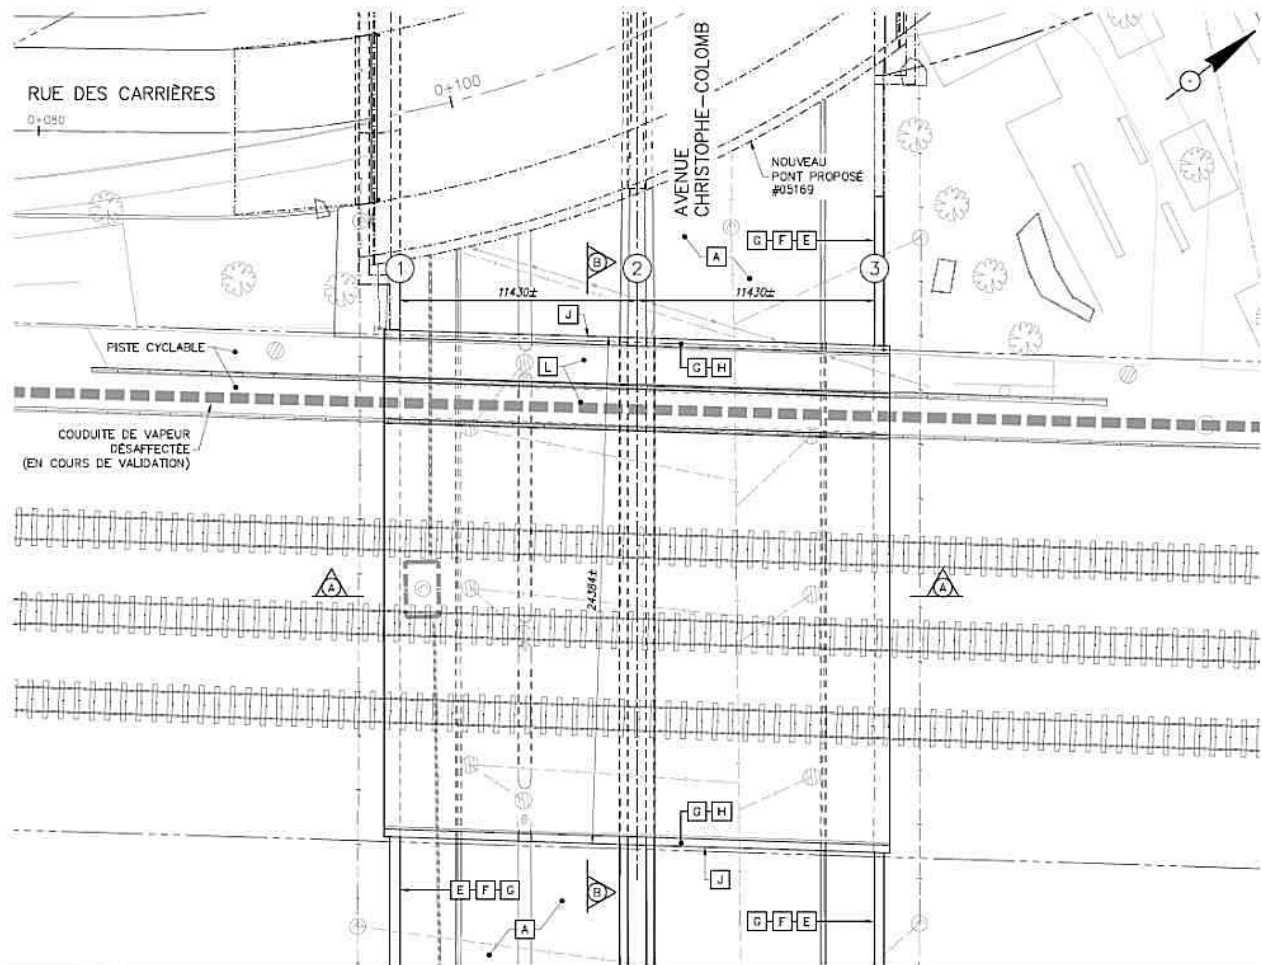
Extrait du plan d'ensemble – Vue en plan
